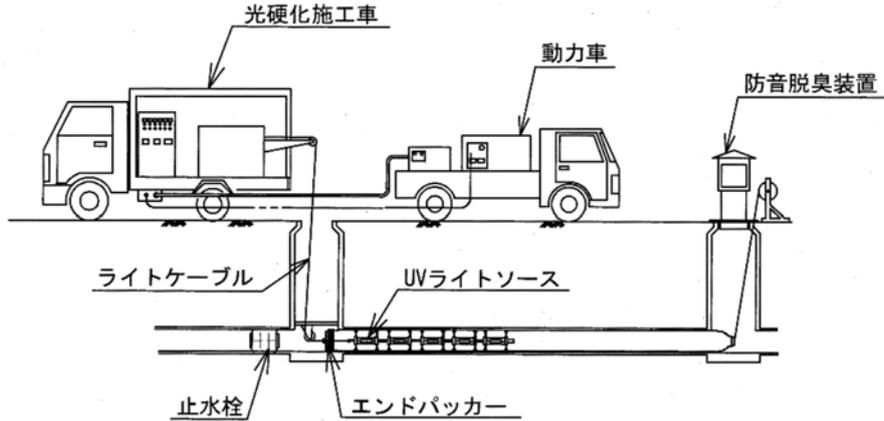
光硬化タイプ（引込方式）の標準施工図
